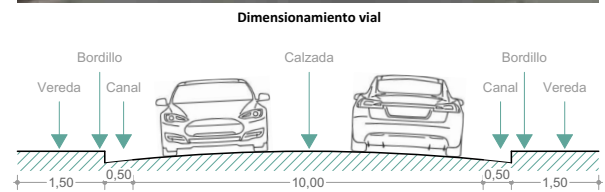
Sección vial Av. Abelardo J. Andrade. Fuente: Autores.
